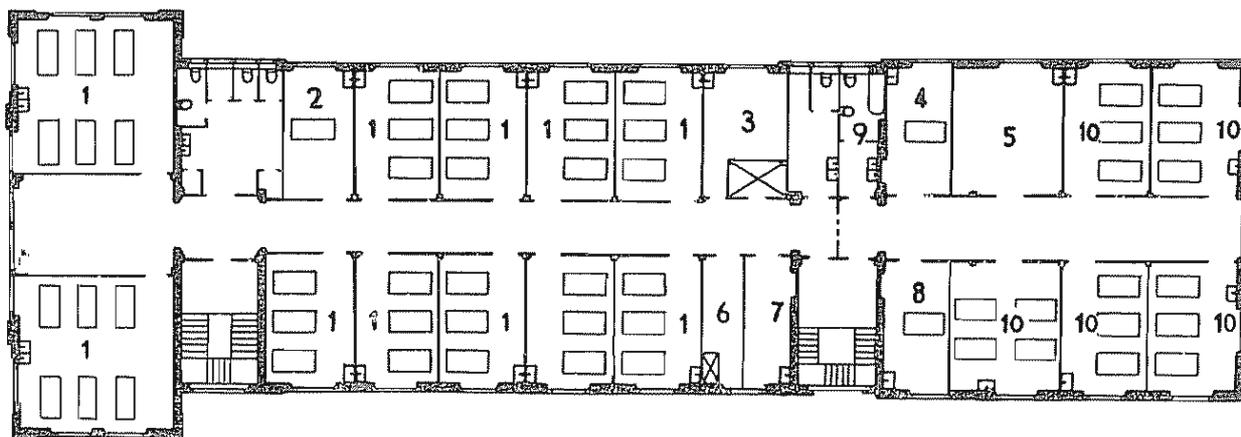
PADIGLIONE CONVITTO INFERMIERE DIPLOMATE - PIANTA DEL TERZO PIANO
